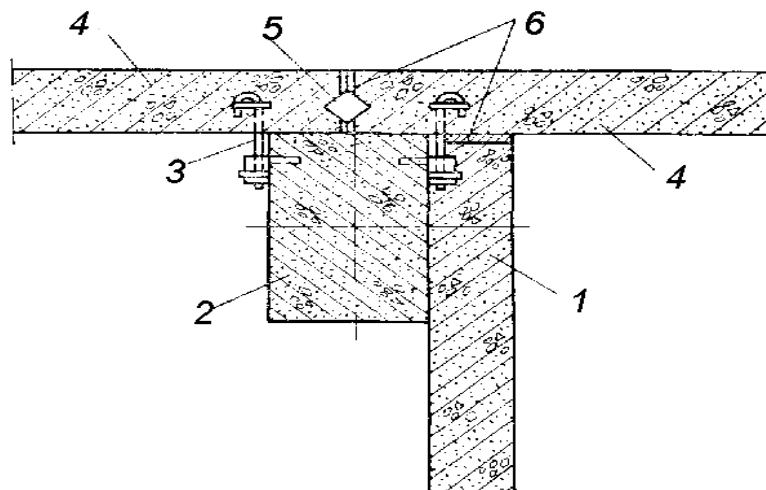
Схема кріплення стінової панелі зовнішньої стіни до колони каркаса протипожежної стіни:
